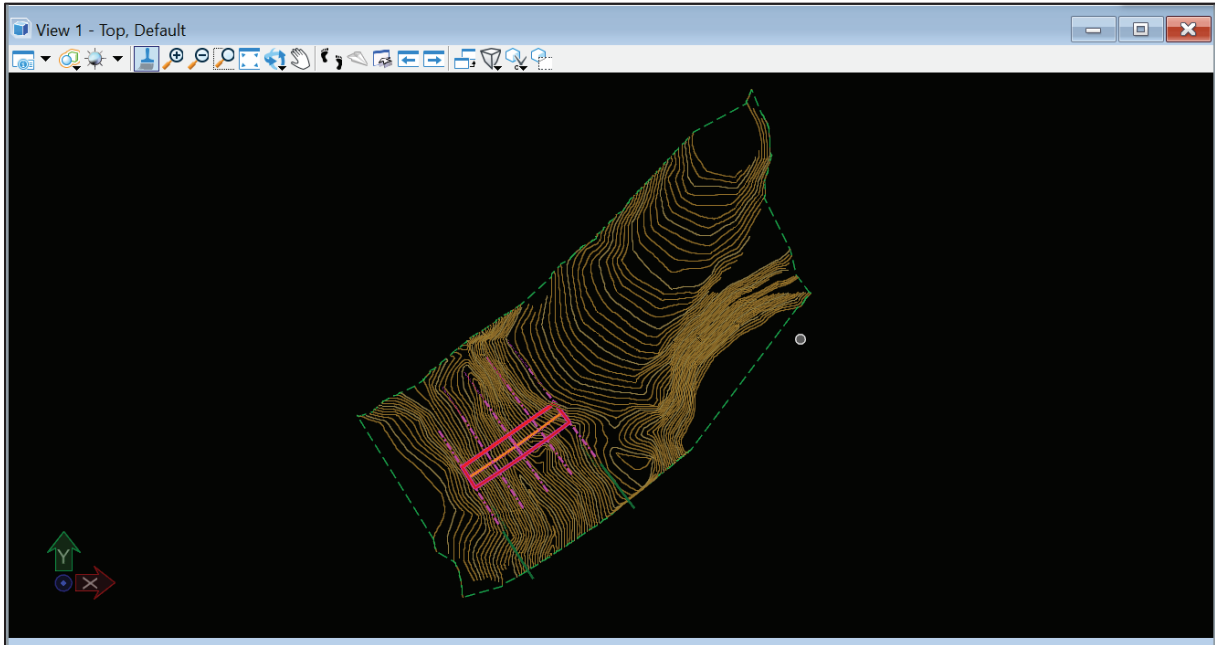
vue en plan les lignes de support et la dalle du pont
